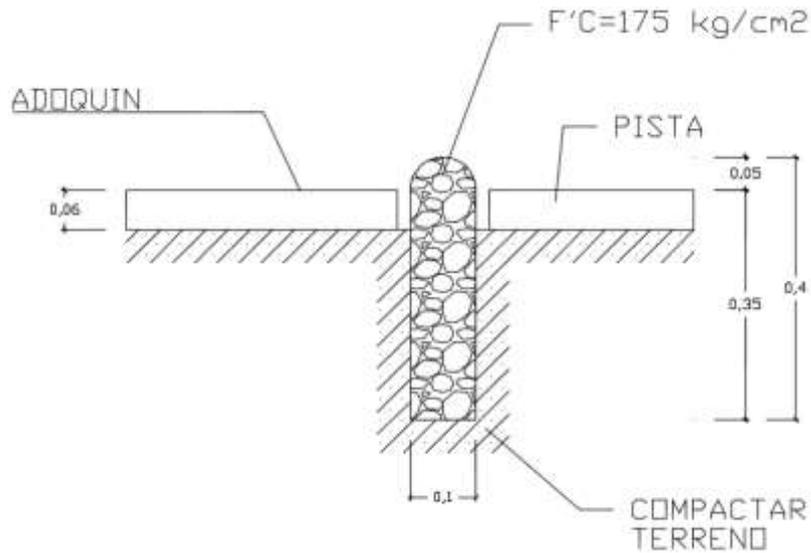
Sección de la sardinela burbuja. Tomado de Estudio definitivo para la construcción de pistas y veredas en la obra vial distrito de La Joya 2018.
